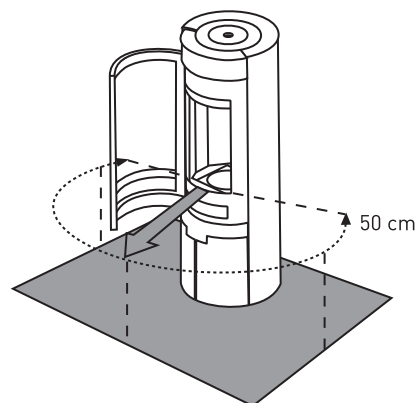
| Dimensionnement de la plaque de base pour poêles-cheminées pivotants
